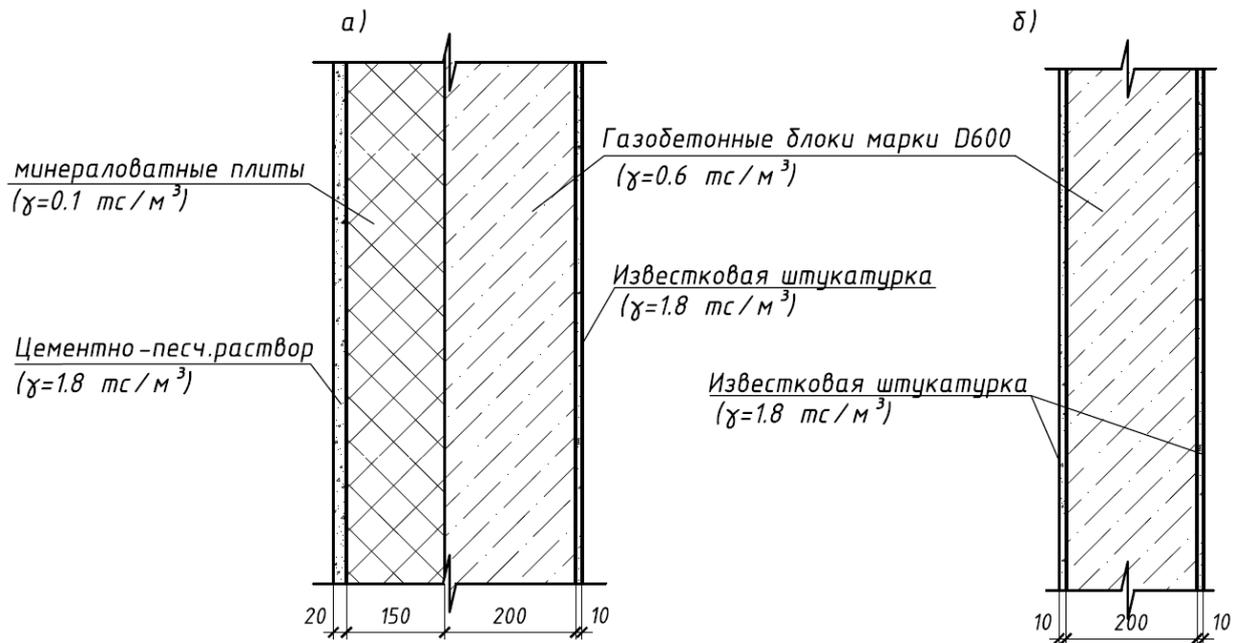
Конструктивные схемы стен: а) наружная стена; б) перегородка.
